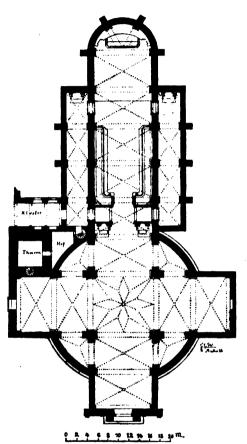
Abteikirche zu Averbode. Grundriss.
